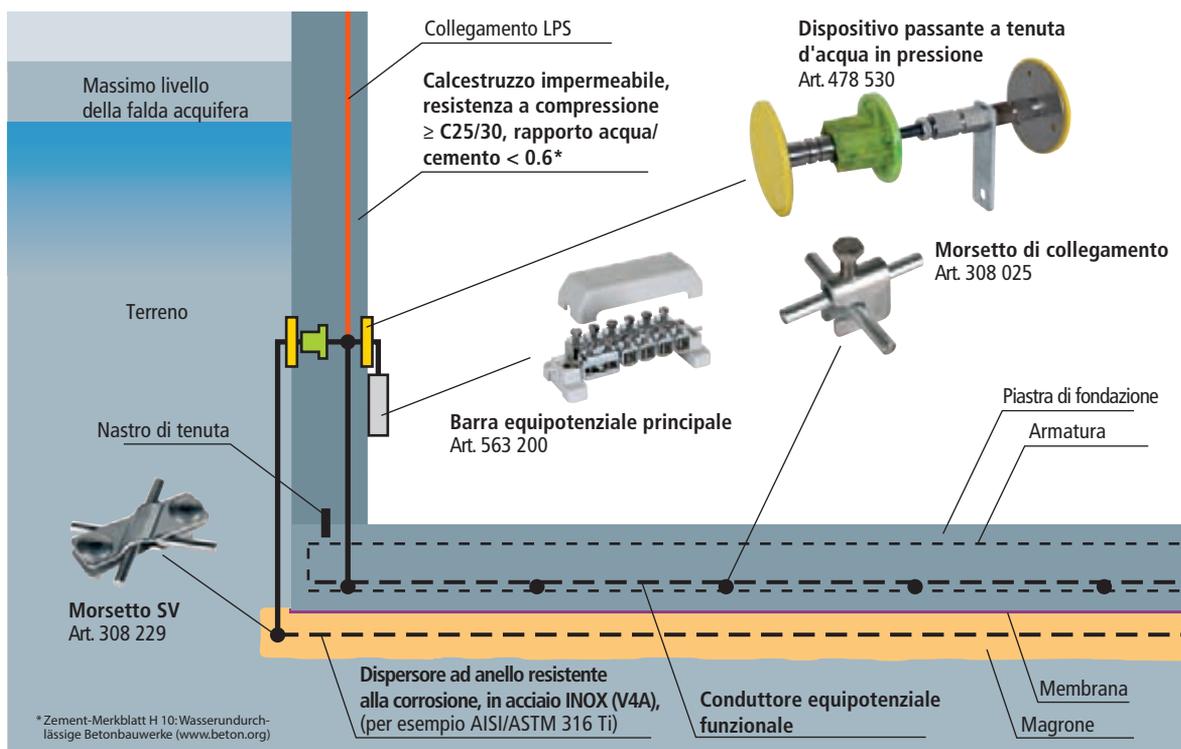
Disposizione del dispersore di fondazione con platea di fondazione chiusa "vasca bianca"
